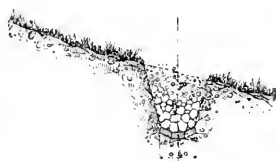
Coupe d'un Drain de 1^{er} ordre.
